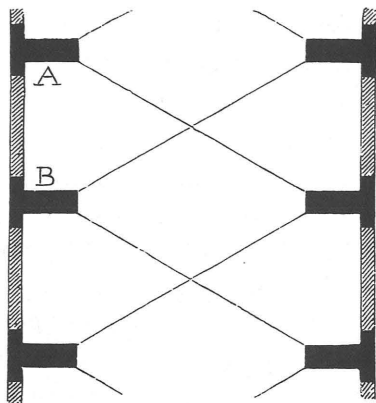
Planta de una nave abovedada con contrafuertes interiores
